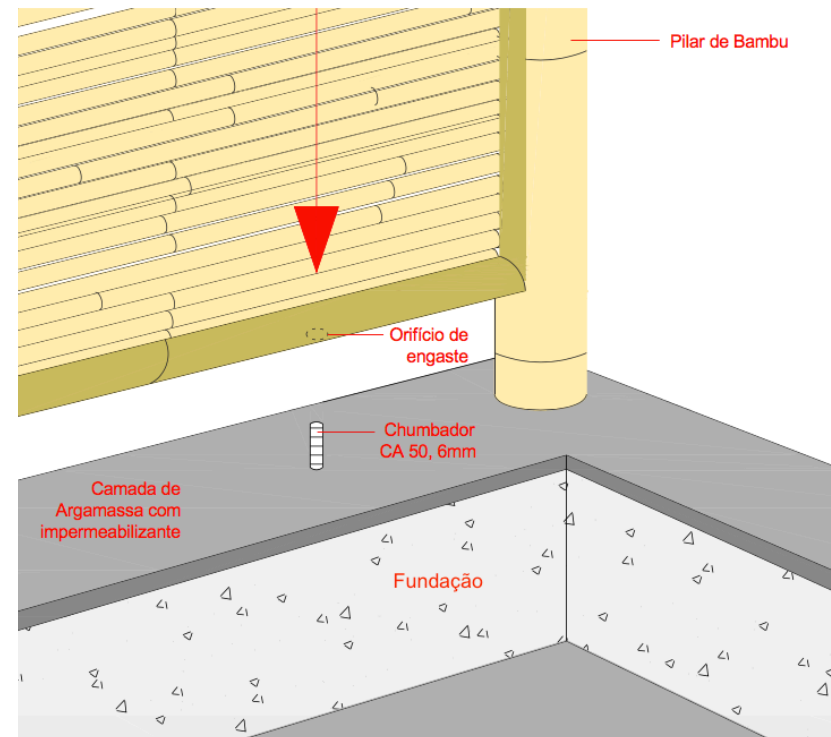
Detalhe da fixação do painel com a viga baldrame.
